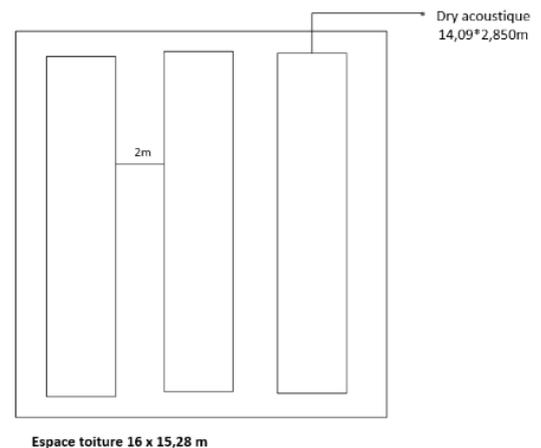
Espace toiture nécessaire pour évacuer 3MW de chaleur, soit un groupe froid
